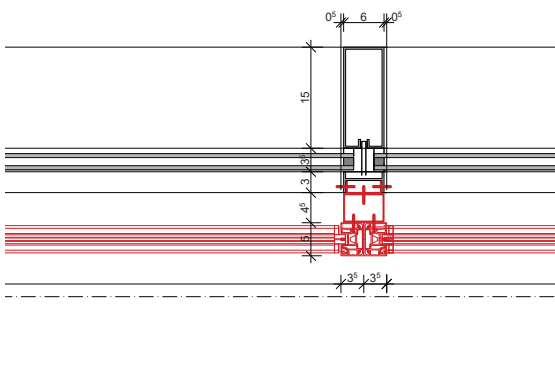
/ Sturz EG Nord-Ost-Fassade Notausgang
